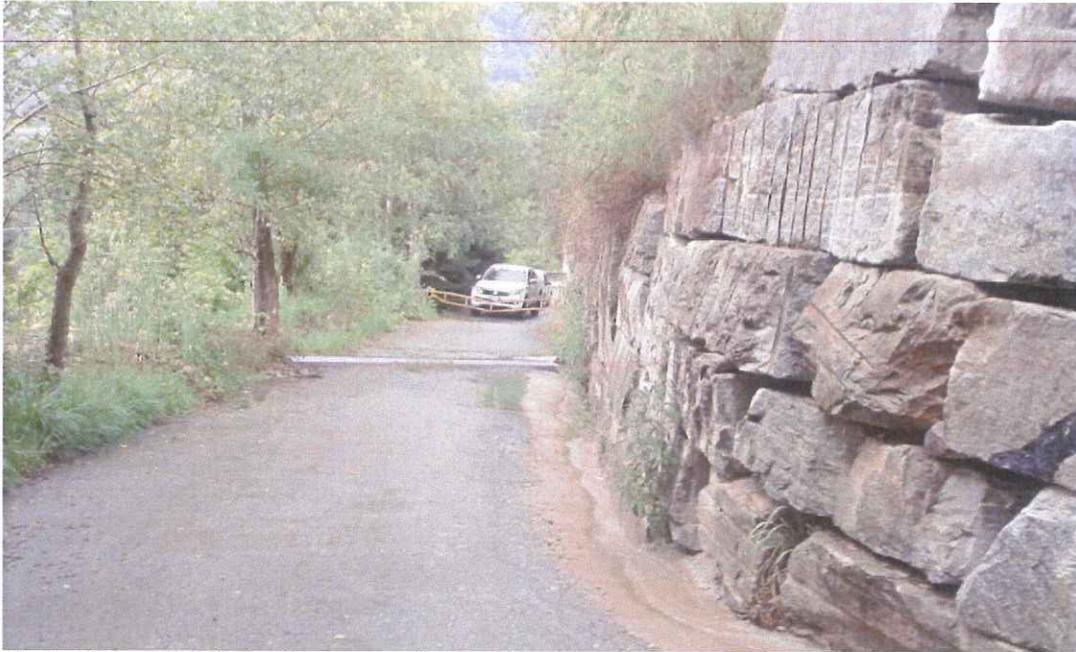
la strada di accesso e il muro di sostegno del sovrastante piazzale
